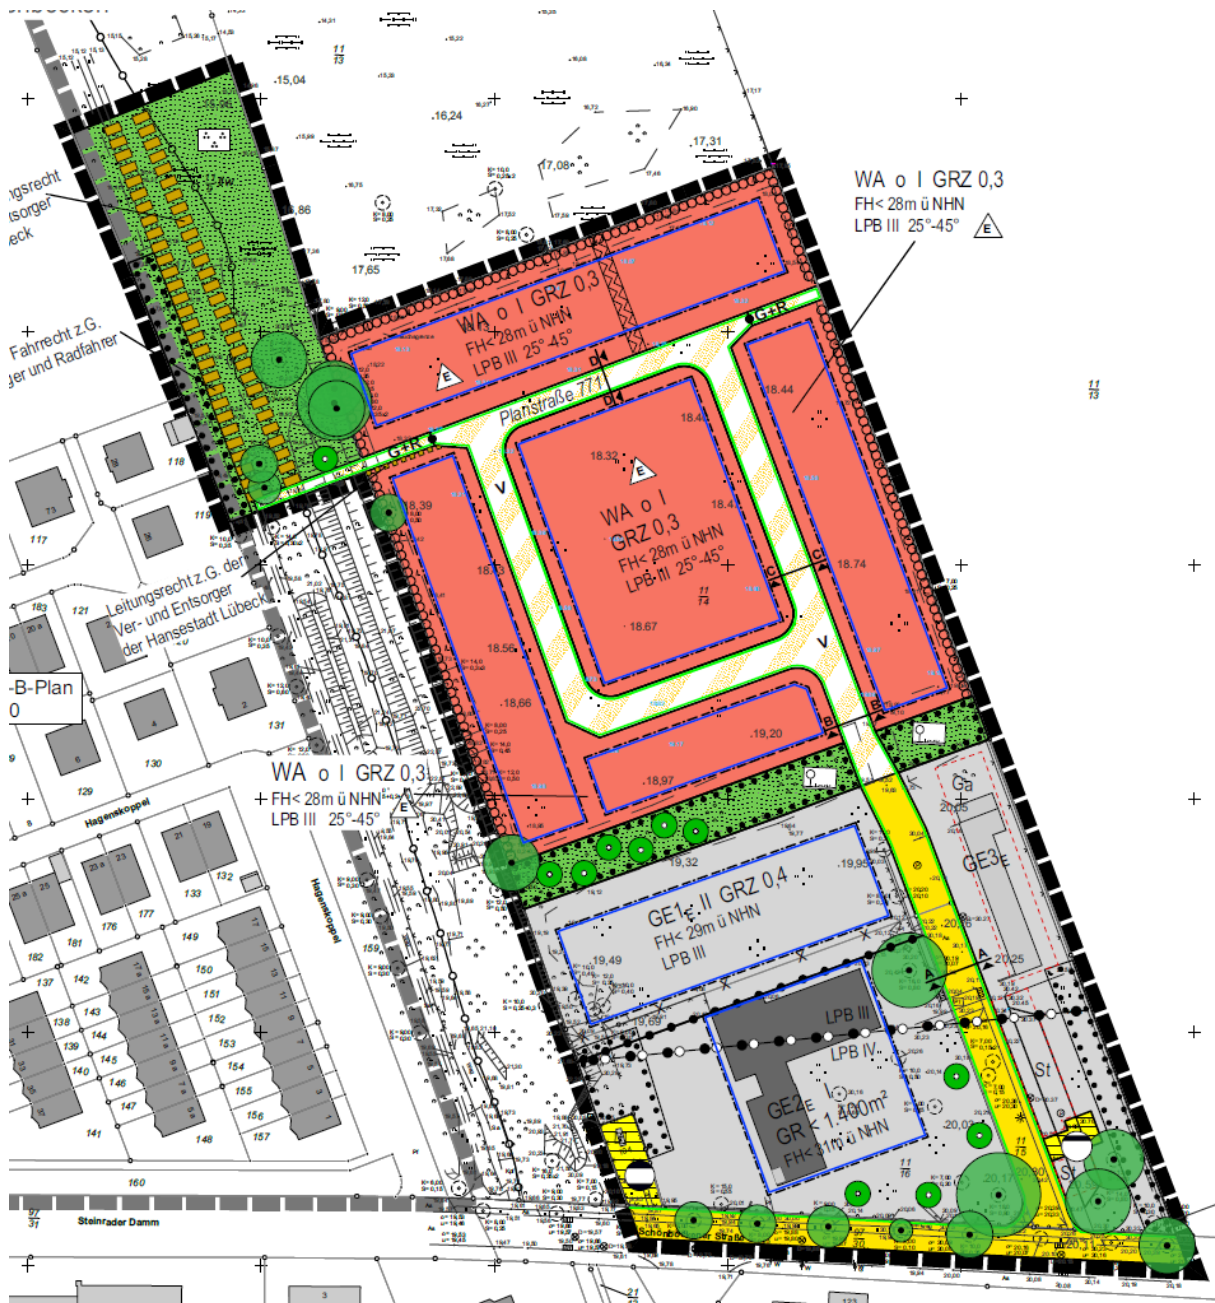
Standort und Grundzüge der Planung (Stand: 19.01.2018)
